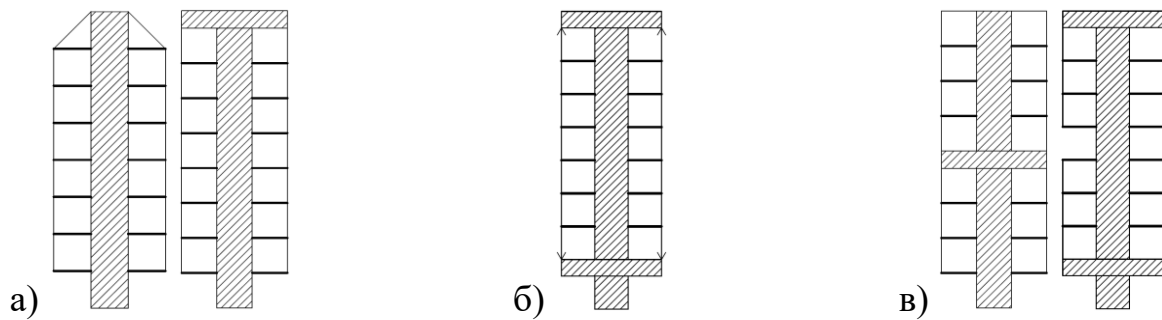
Здания консольно-подвесной конструктивной системы: а) с подвешенными по периметру консольными перекрытиями в уровне каждого этажа; б) с преднапряжёнными вантами между консольными поясами в уровне верхних и нижних этажей; в) с перекрытиями, подвешенными к консольному поясу или опирающимися на него
